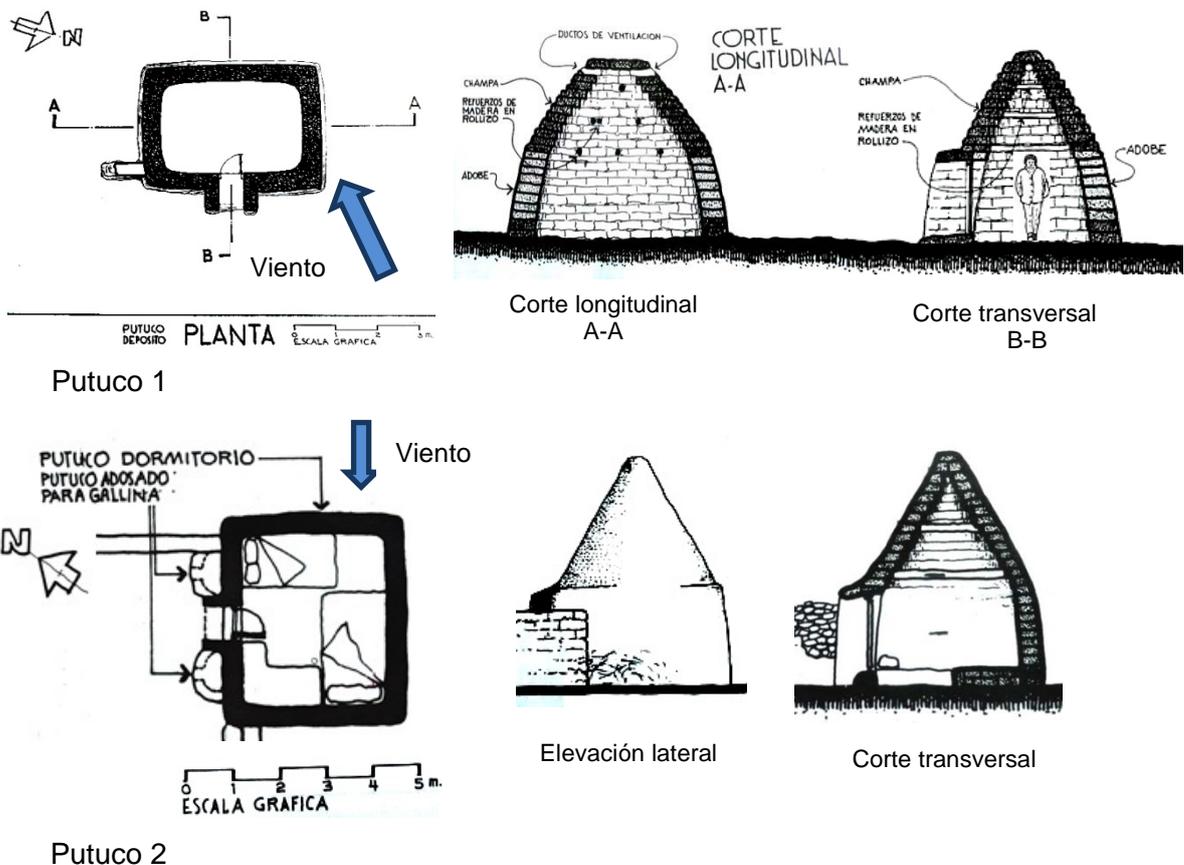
Planta y cortes del Putuco 1 (destinado a depósito) y del Putuco 2 (destinado a dormitorio) (Marussi, 1999)
